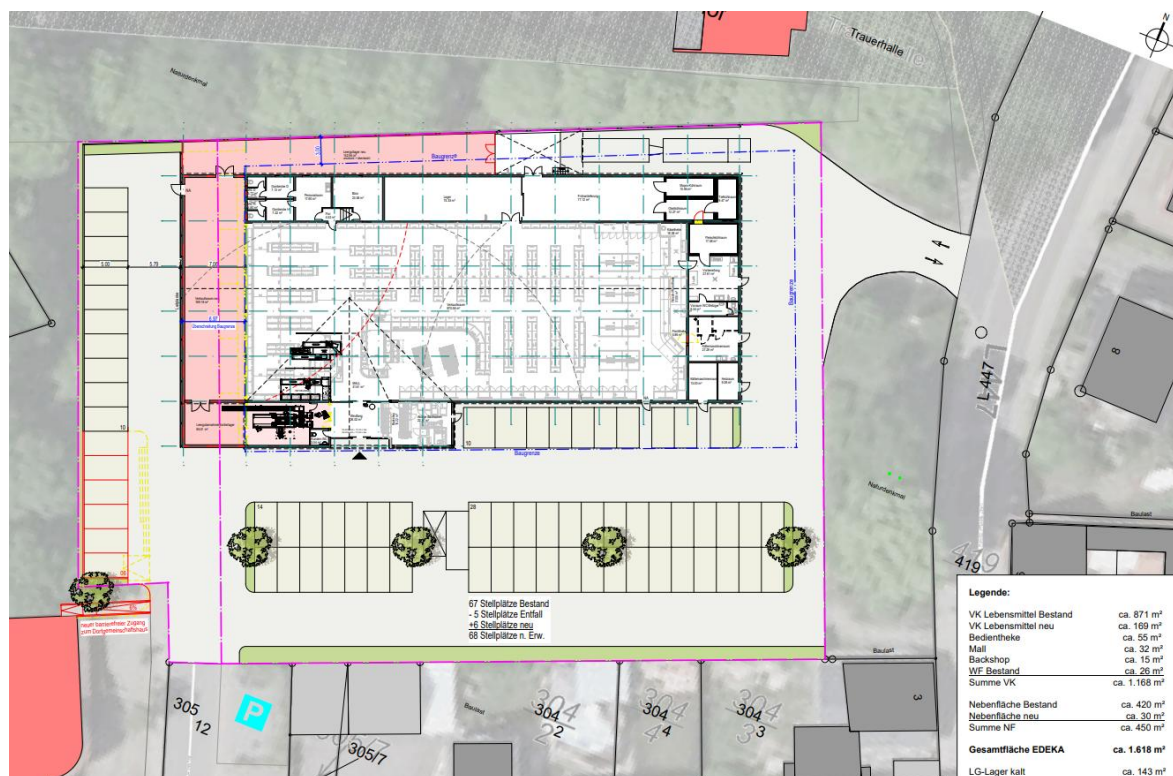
Grundriss Bestand und Erweiterung des Edeka⁶
